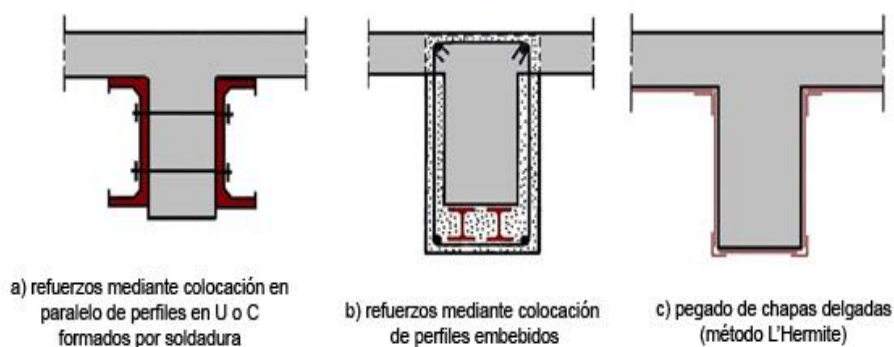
Encamisado de vigas con perfiles metálicos.⁴⁶
